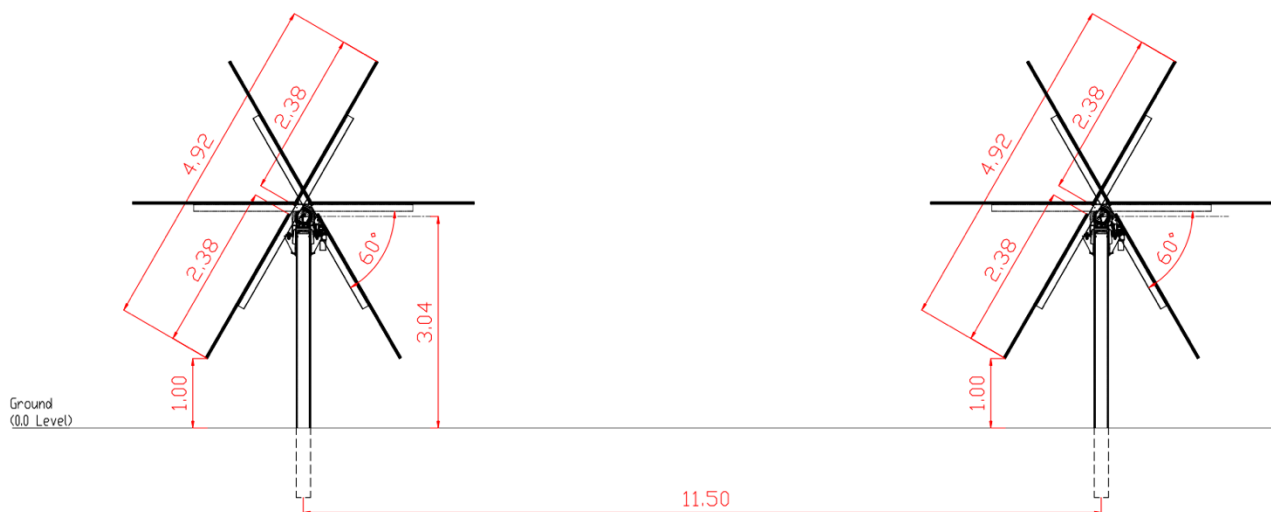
Sezione tipo delle stringhe fotovoltaiche a progetto quando l'inclinazione è pari a 0°, pitch 11,5 metri.
